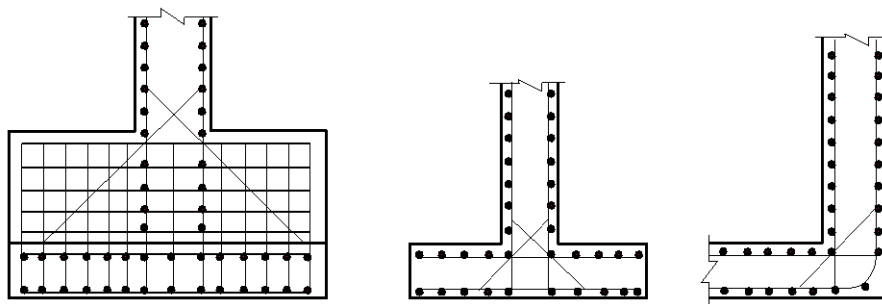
門柱と堰柱との結合部、堰柱と床版との結合部の配筋
